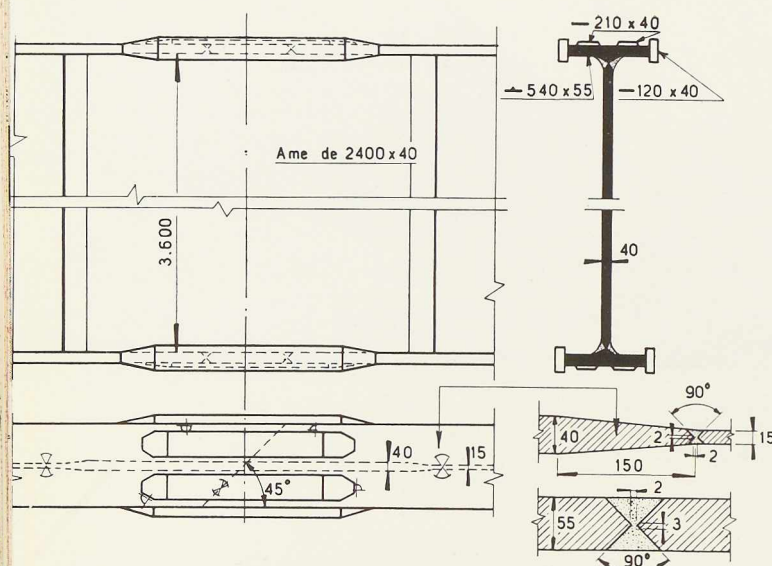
Joint bout à bout des poutres du pont-rails (partie Dörnen).
